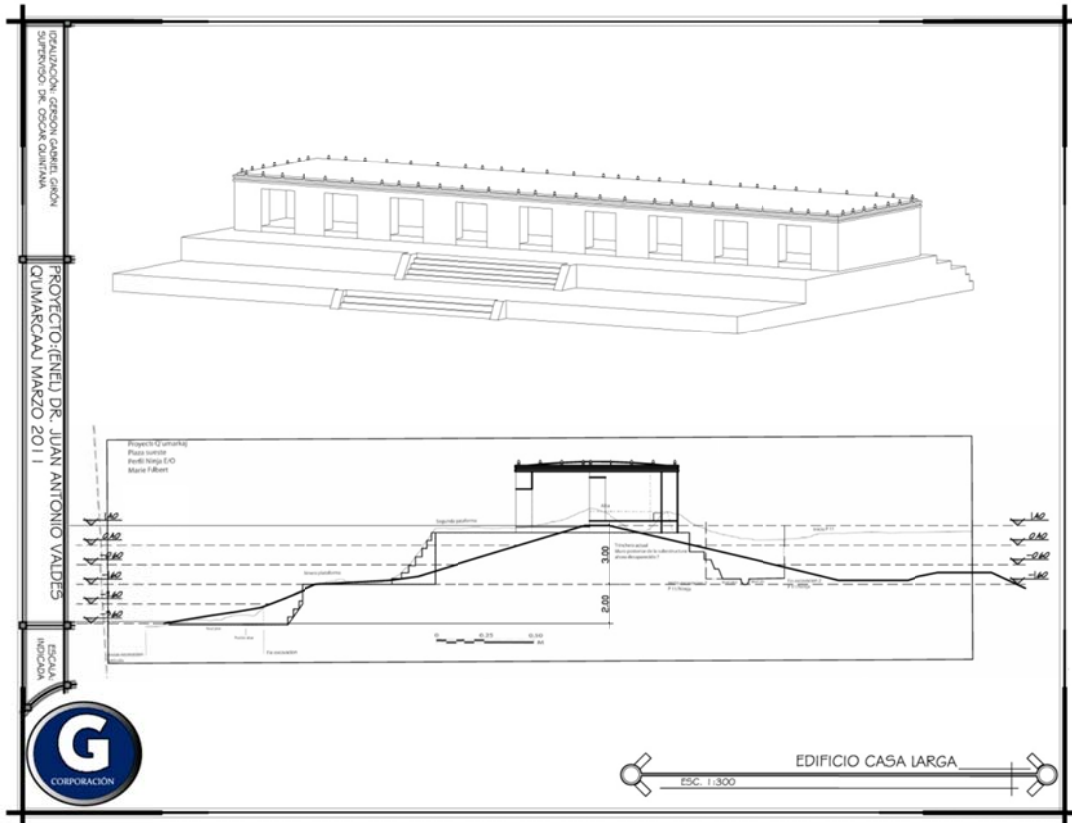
, PLANTA Y 3D GERSON GABRIEL GIRÓN / CASA LARGA
